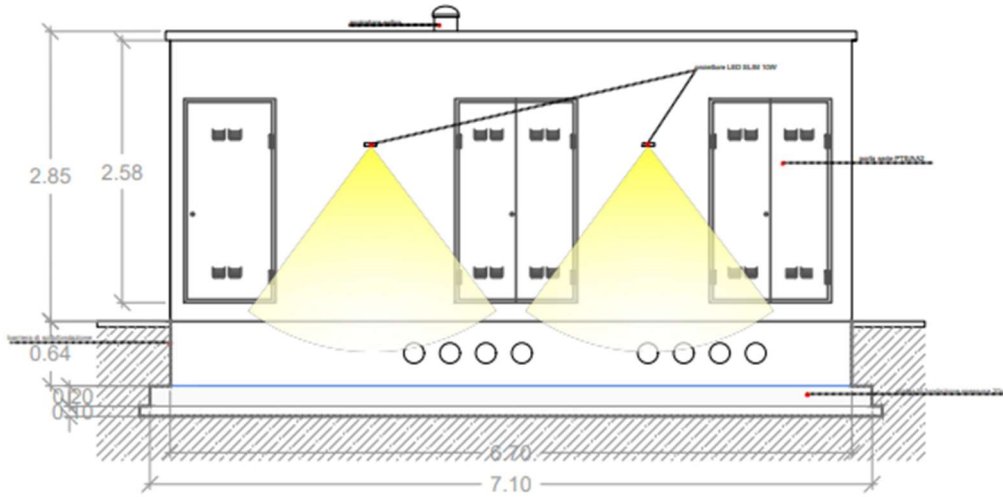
Prospetto frontale con platea di fondazione della cabina Utente per la Consegna
